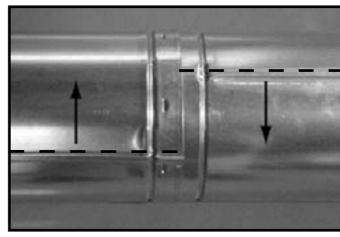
Faire pivoter les joints d'assemblage pour démonter
